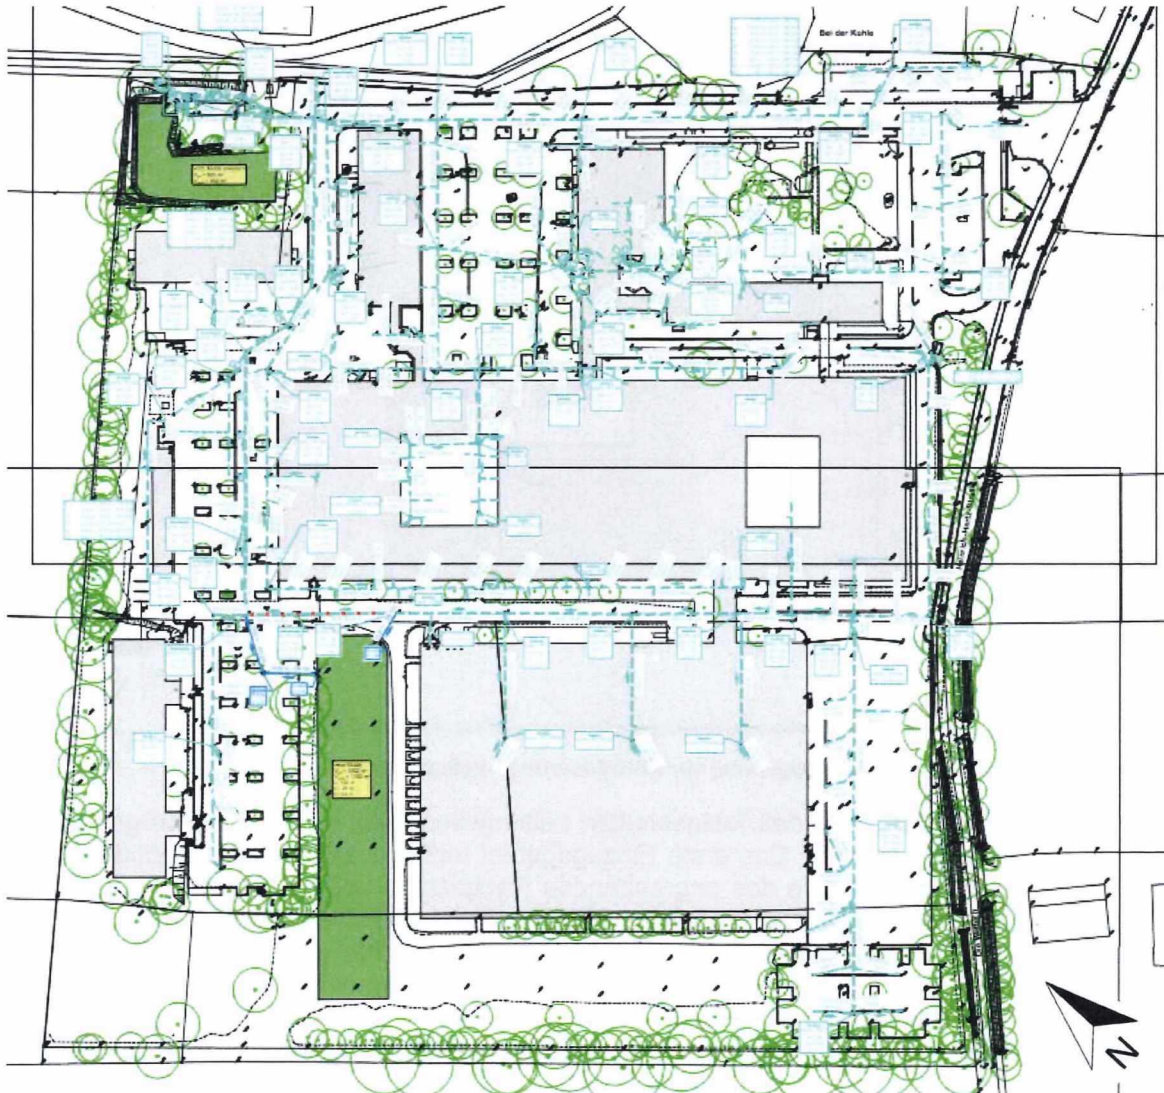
Lageplan Entwässerung, maßstabslos, d+p, April 2020
